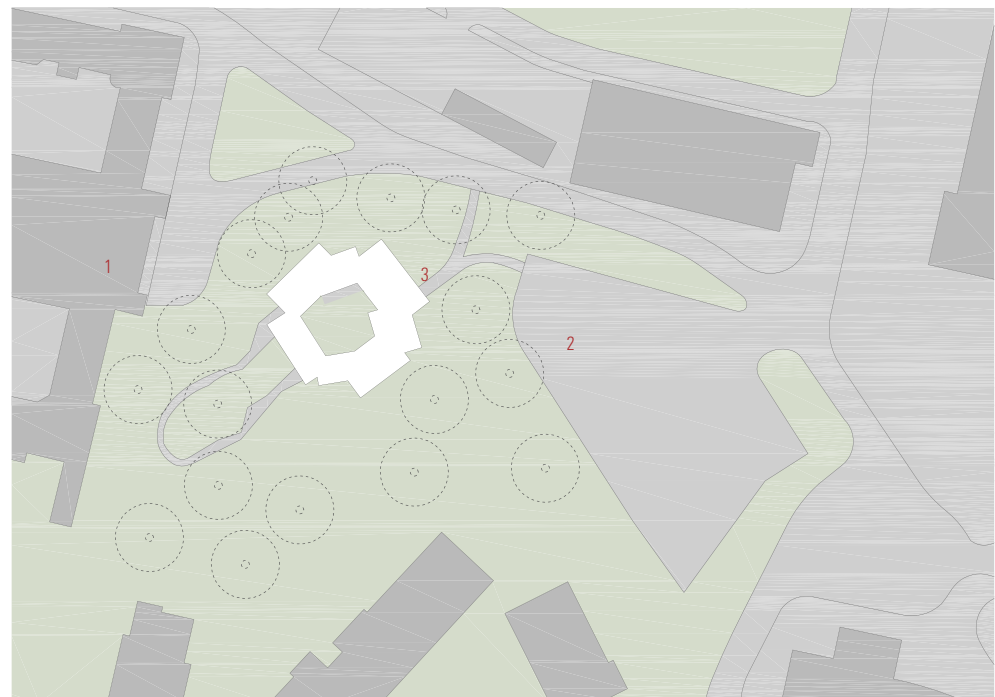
Maggie's Gartnavel* - Planta de implantação
